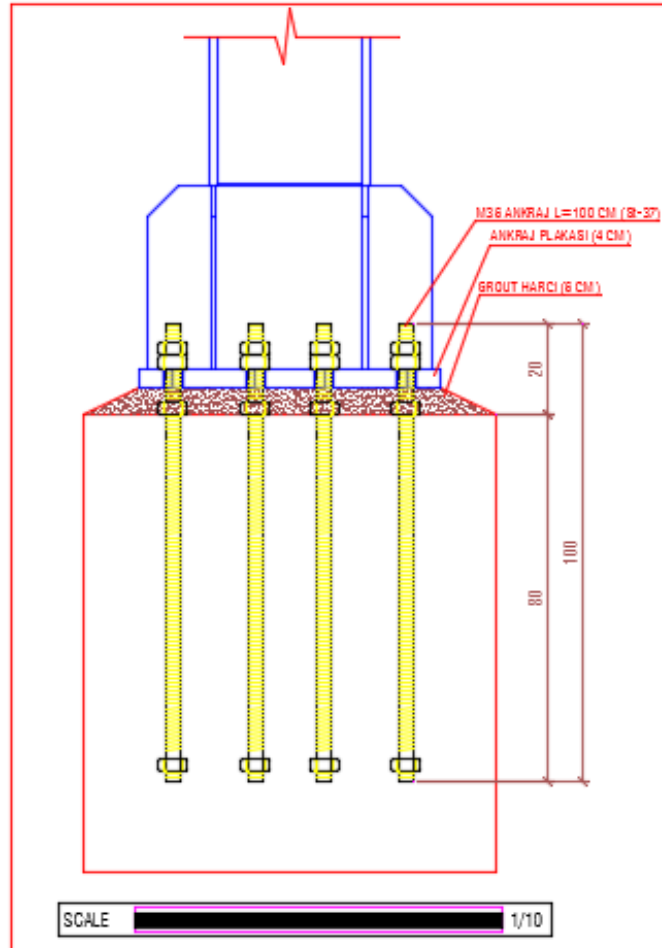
Örnek Proje-2 temel planından bir bölüm (Epas Mühendislik)
